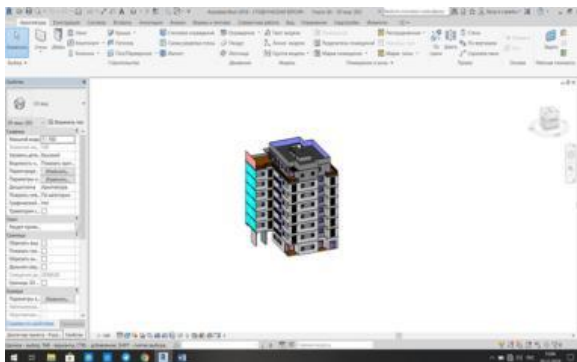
3D модель 8 – поверхової житлової будівлі
